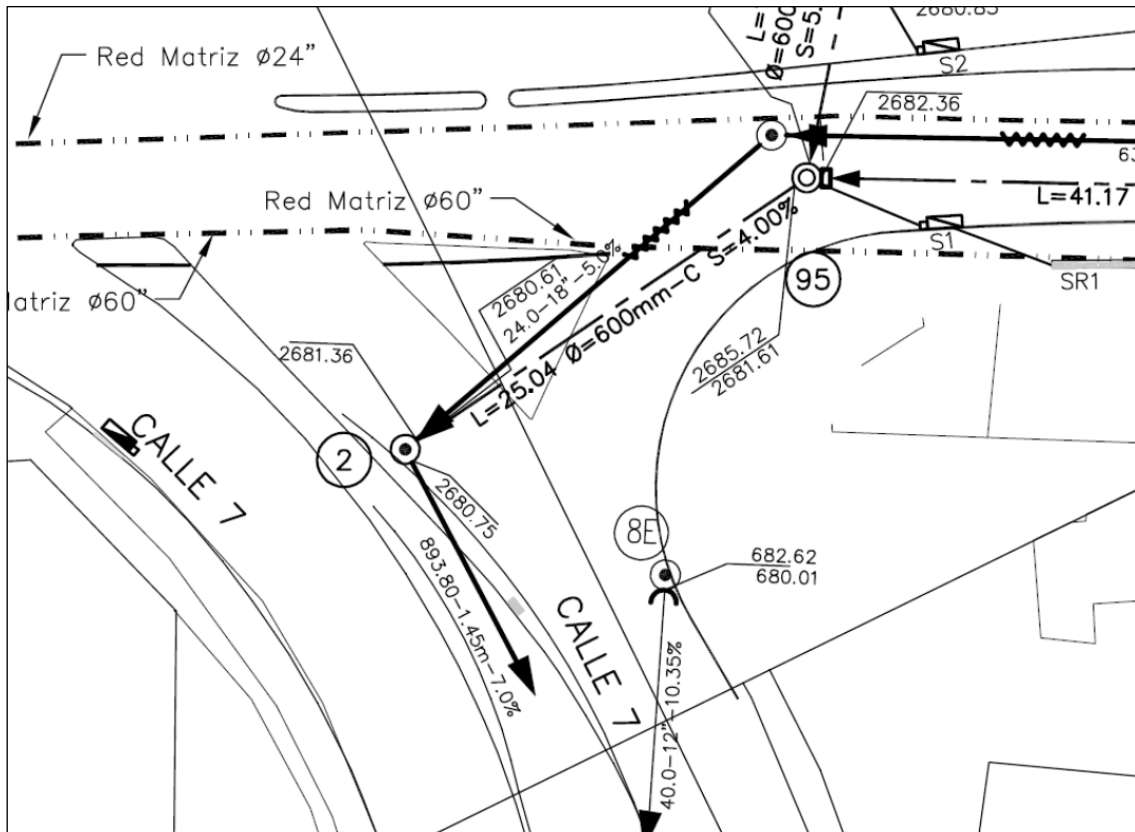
Planta del tramo de alcantarillado propuesto para la conexión del Pozo 95 con el Pozo 2, a instalar mediante tecnología sin zanja. Tomado de: (Rodríguez Gutierrez, Molano Garay, & Vargas Manrique, 2016)
